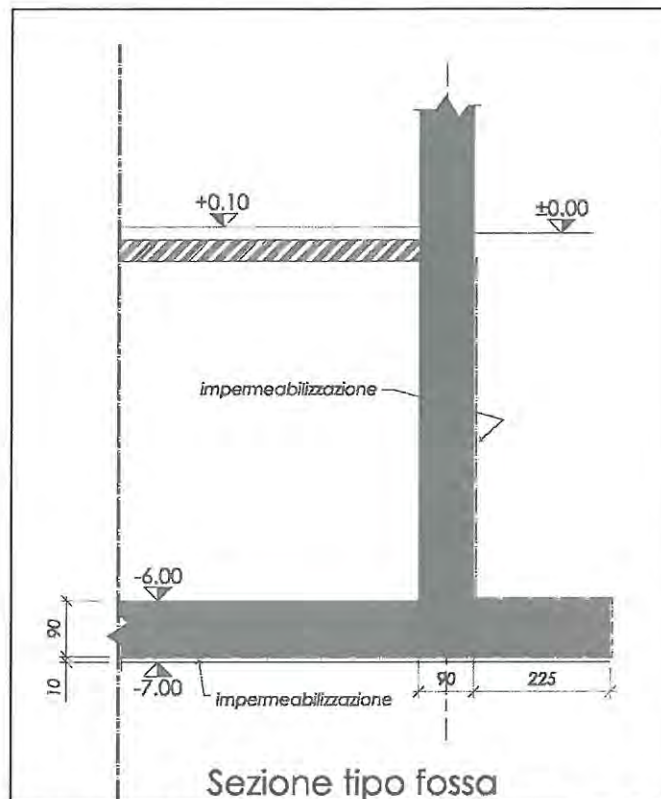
particolare impermeabilizzazione fossa rifiuti (sezione)
